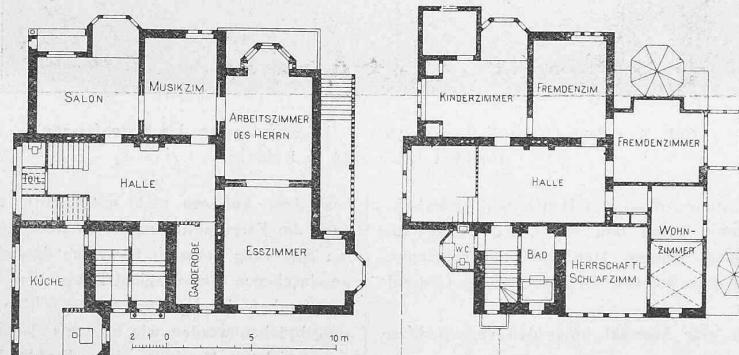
Villa Castenholz in Koblenz. — Grundrisse vom Erdgeschoss und I. Obergeschoss.
